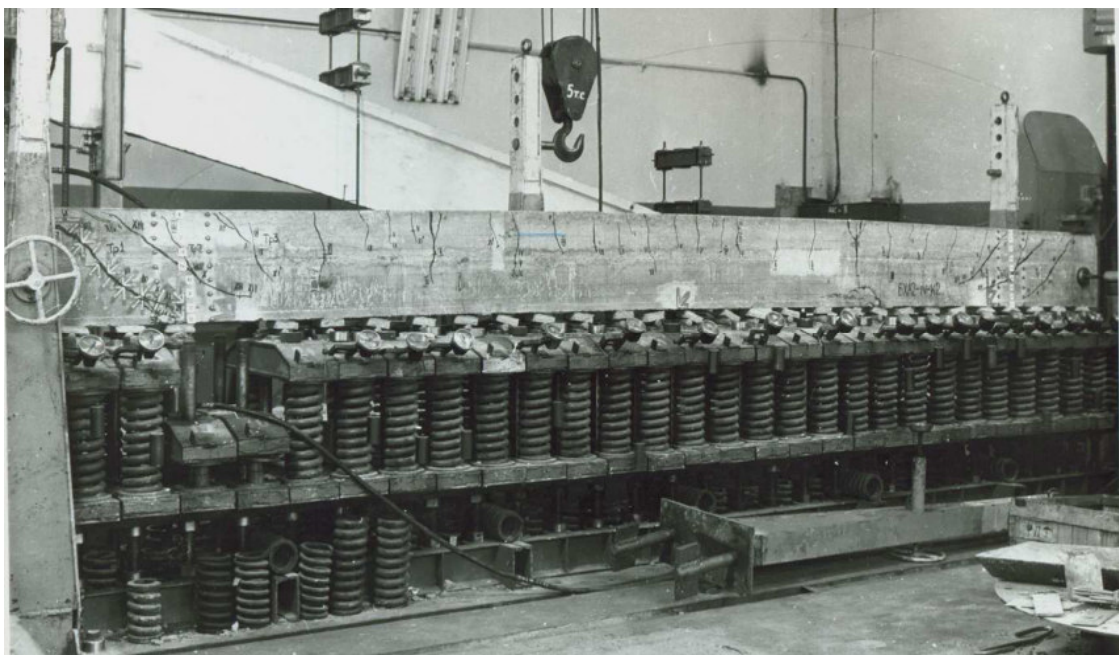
Конструкція установки і загальний вигляд випробувань балок на деформованій основі
